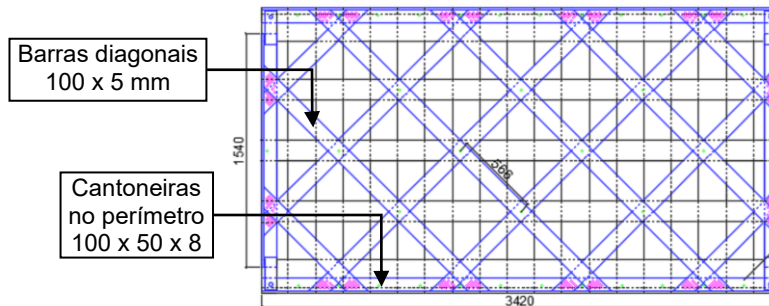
Disposição das barras e cantoneiras no reforço. (Dimensões em mm) (Adaptado de Nunes, (2017))
